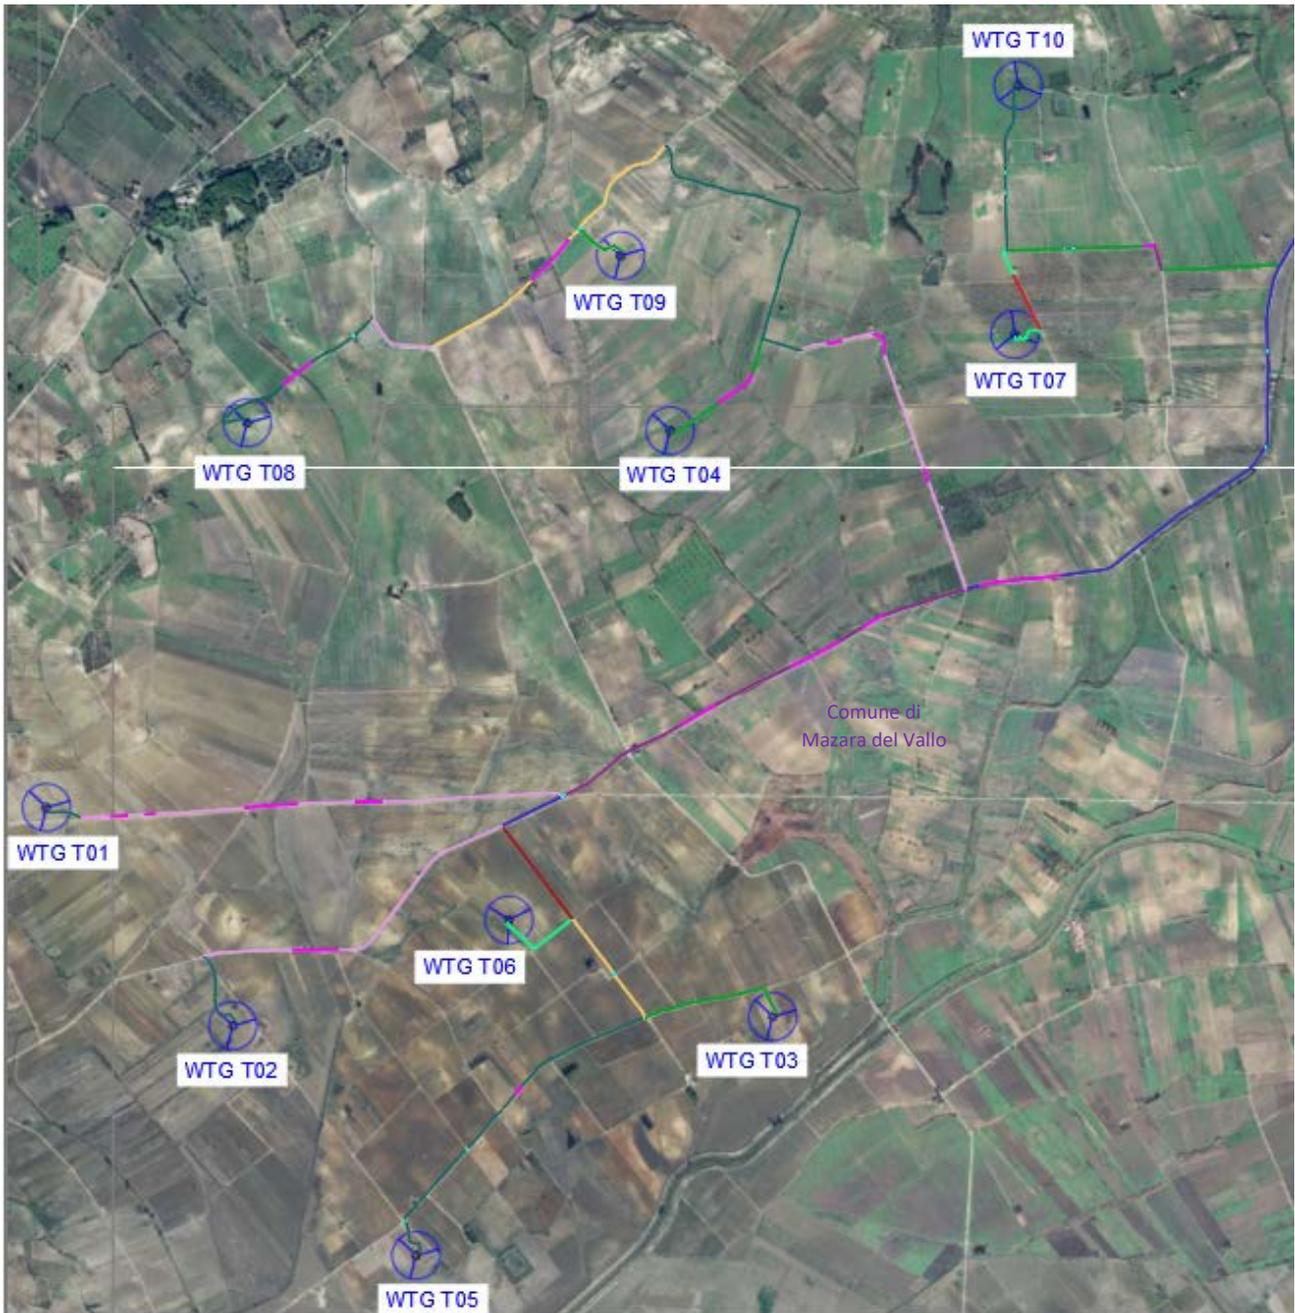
Layout della rete MT su ortofoto - impianto eolico
